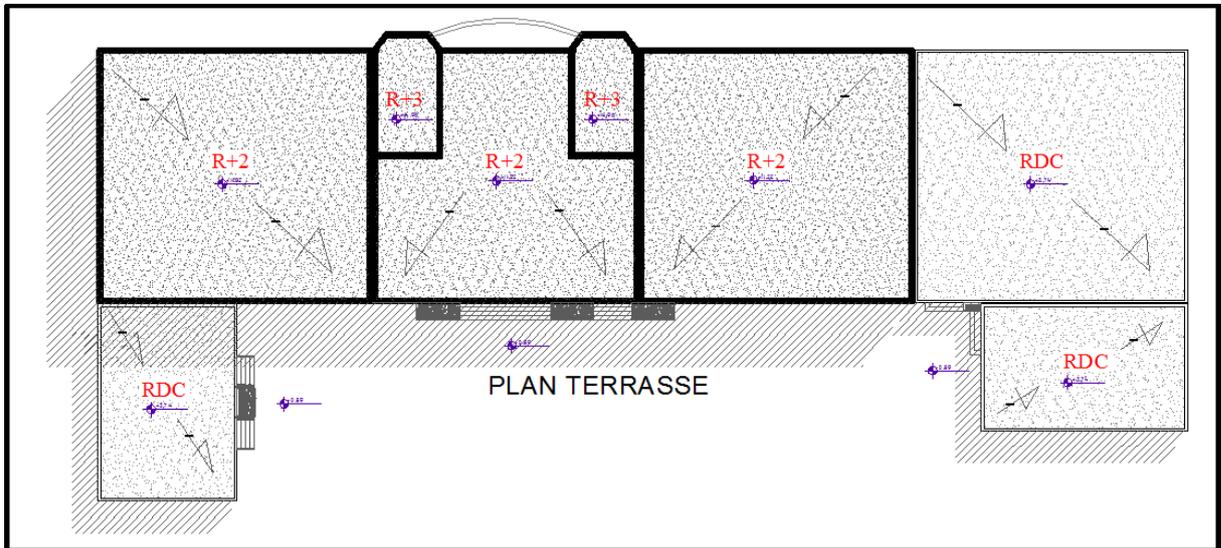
plan terrasse du collège (source SARL ICARA)
